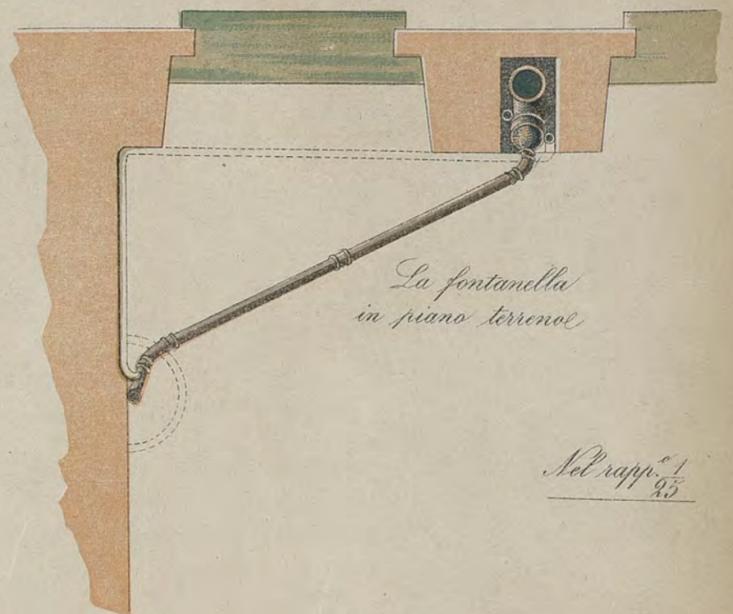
La pianta del tubo di scarico e di ventilazione per la fontanella del piano terreno.
